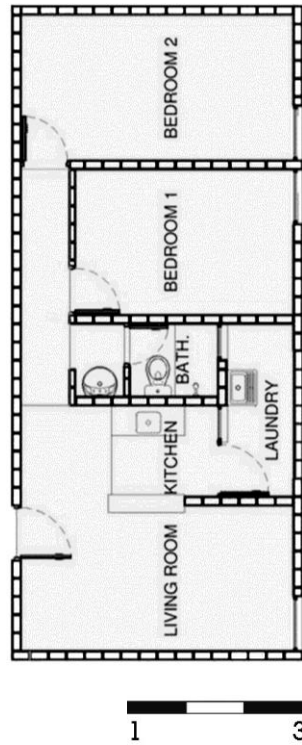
Urb. Jardim Vicentina - Planta de unidad tipo (50 m²)
